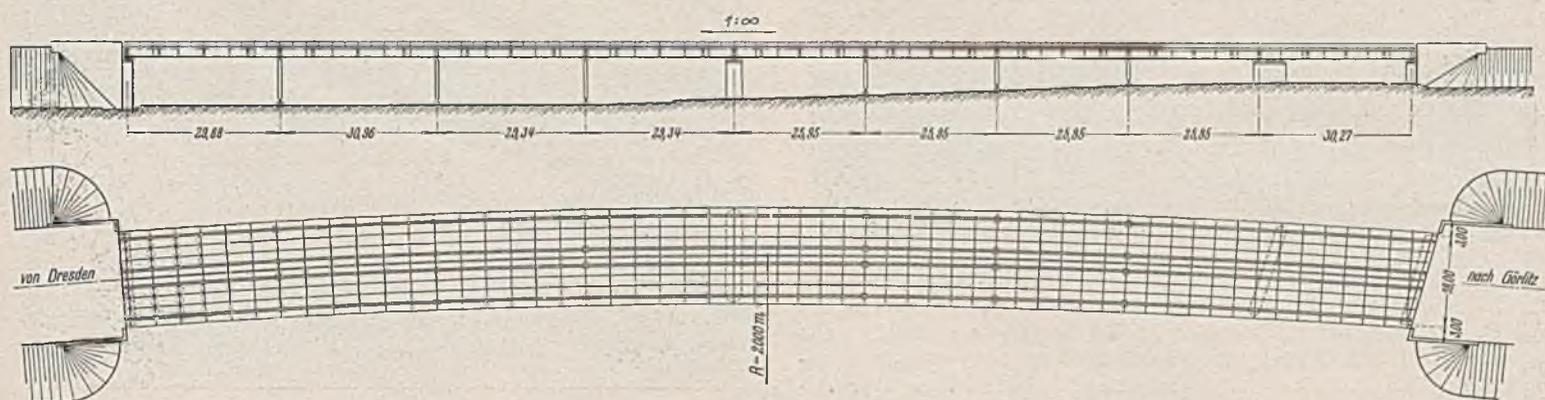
Autobahnbrücke am Bahnhof Radebeul.
